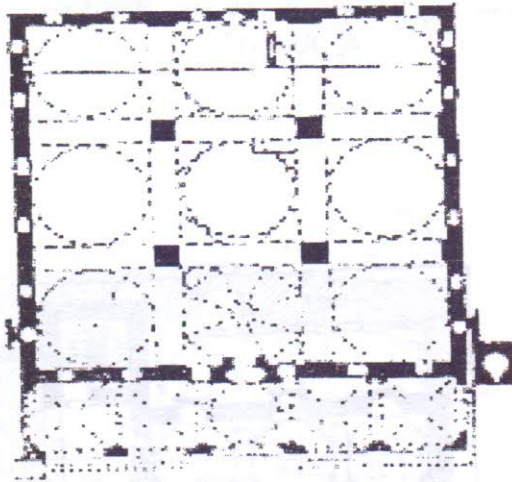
مسقط أفقي لمشهد السبع و سبعين ولي بأسوان جنوب مصر
